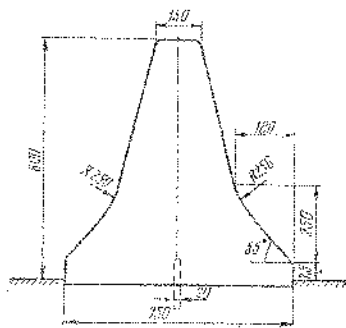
Конструкция железобетонного ограждения паранетного типа
